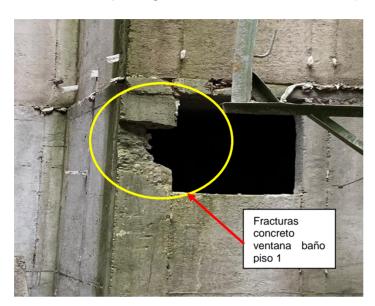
Concreto fracturado en ventana de los baños piso 1 y 3 de la torre 10, apuntalamiento de placa de entrepiso apartamento piso 1 torre 9, muro de división sin el espesor exigido por los planos estructurales, el cual debe ser mínimo 10 cm, Proyecto denominado "Urbanización Santa Sofia II", (Municipio de El Colegio, 30 de mayo de 2019, 1:00 p.m.)
